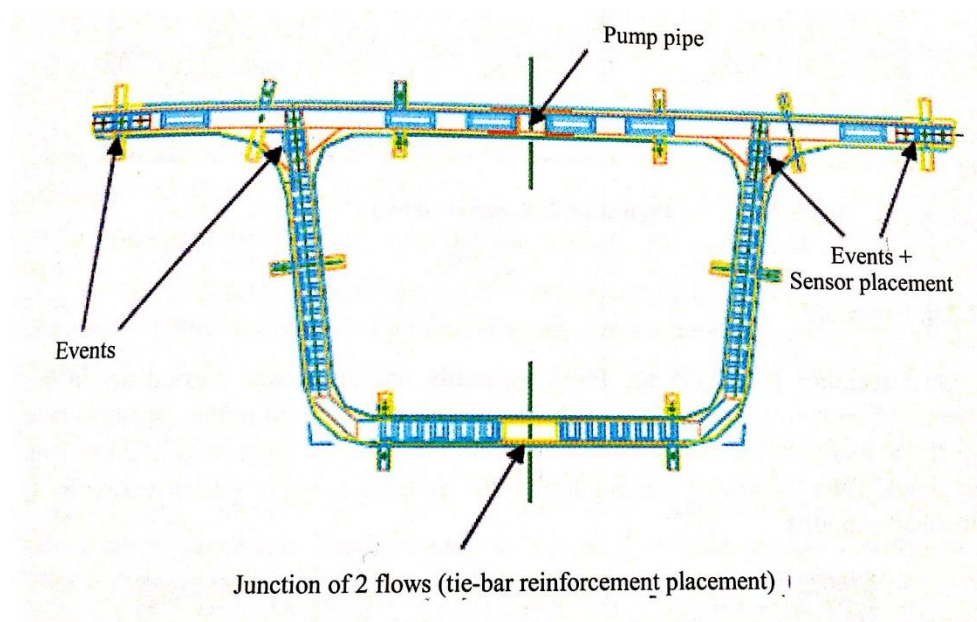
Coupe transversale du caisson (Toutlemonde & Resplendido, 2009)
